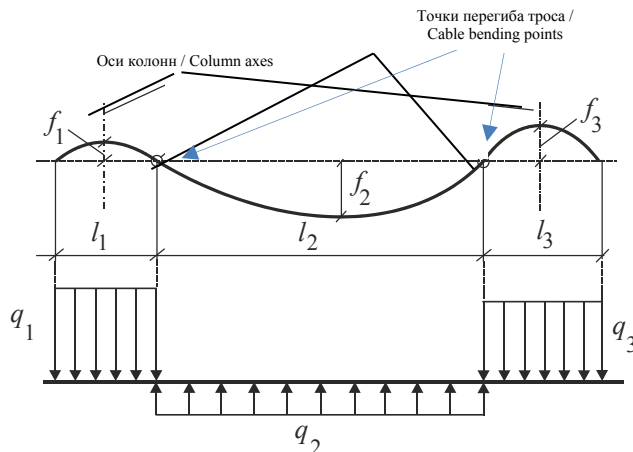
Схема приложения восстанавливающей нагрузки в плите перекрытия
